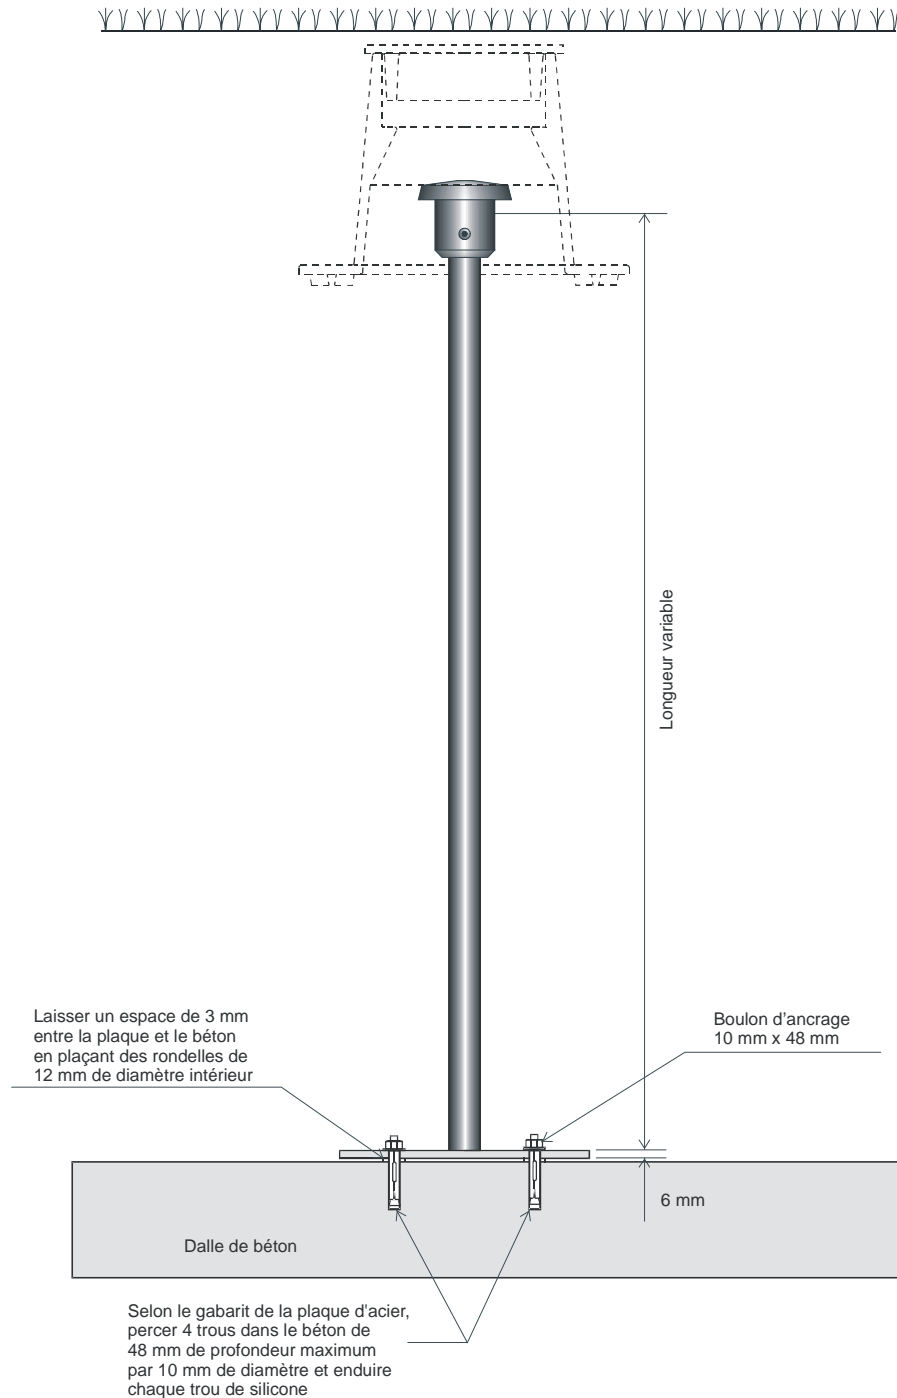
Médaille sur tuyau avec plaque d'ancrage
